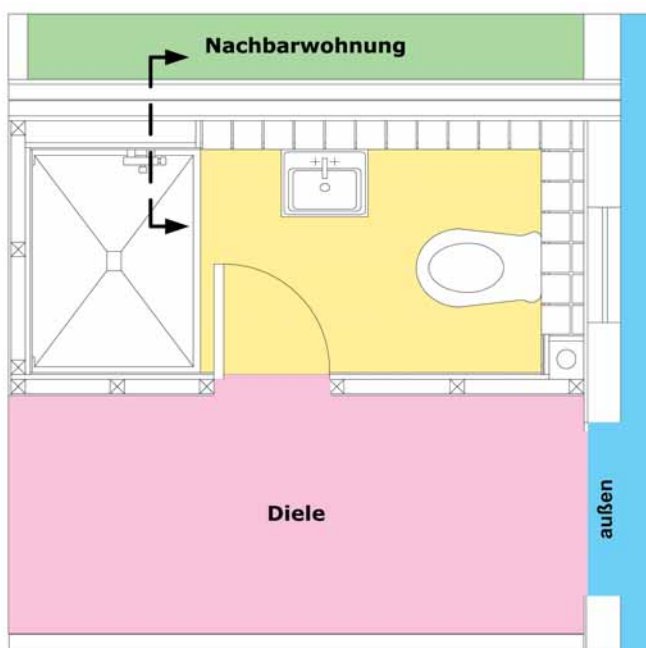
Typische Grundriss-Situation für ein Gäste-Bad mit WC
